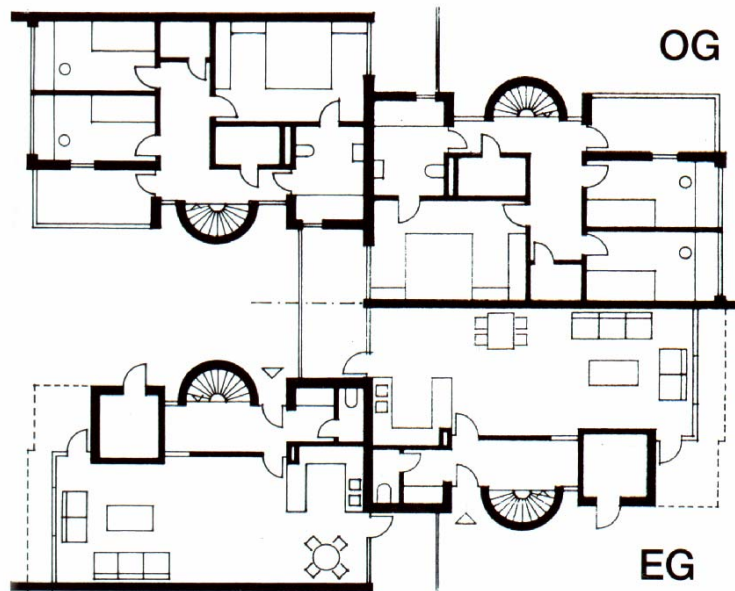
Grundrisse back-to-back Häuser, Architekten Mecanoo
